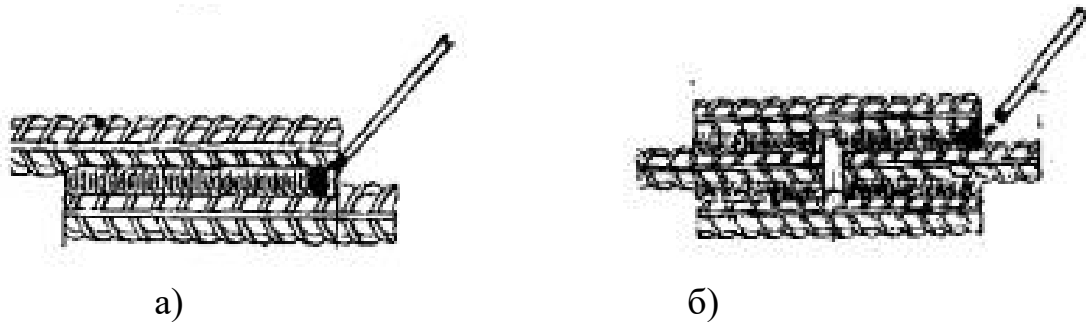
Дугове зварювання. а) зварювання внахлест; б) зварювання внахлест з накладками
